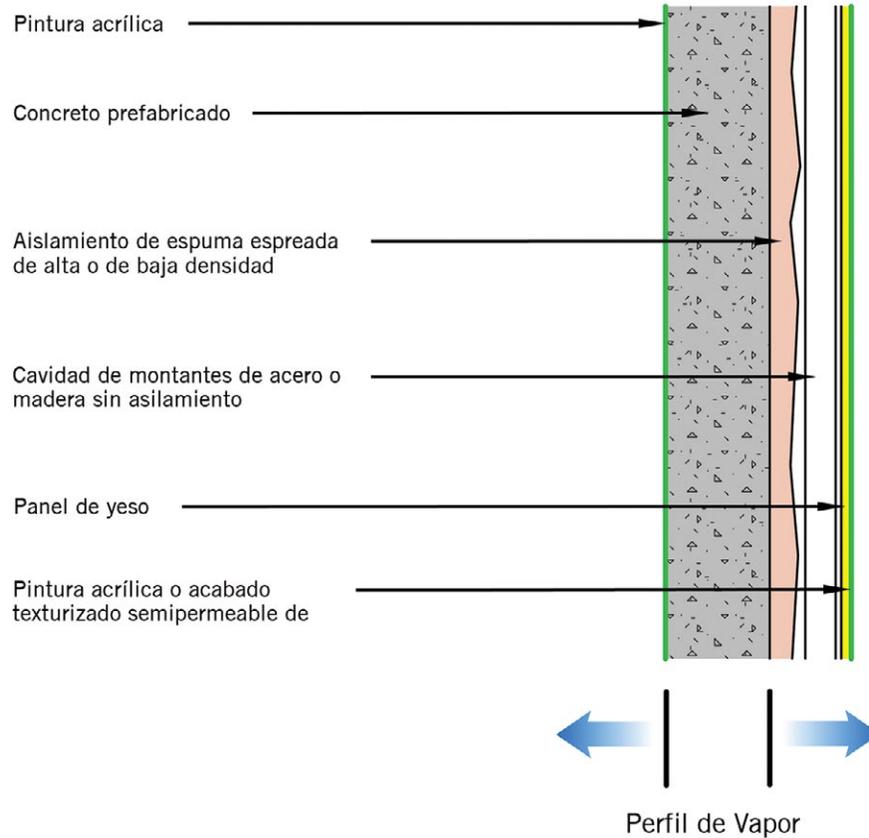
Concreto Prefabricado con Aislamiento Interior de Espuma Atomizada
